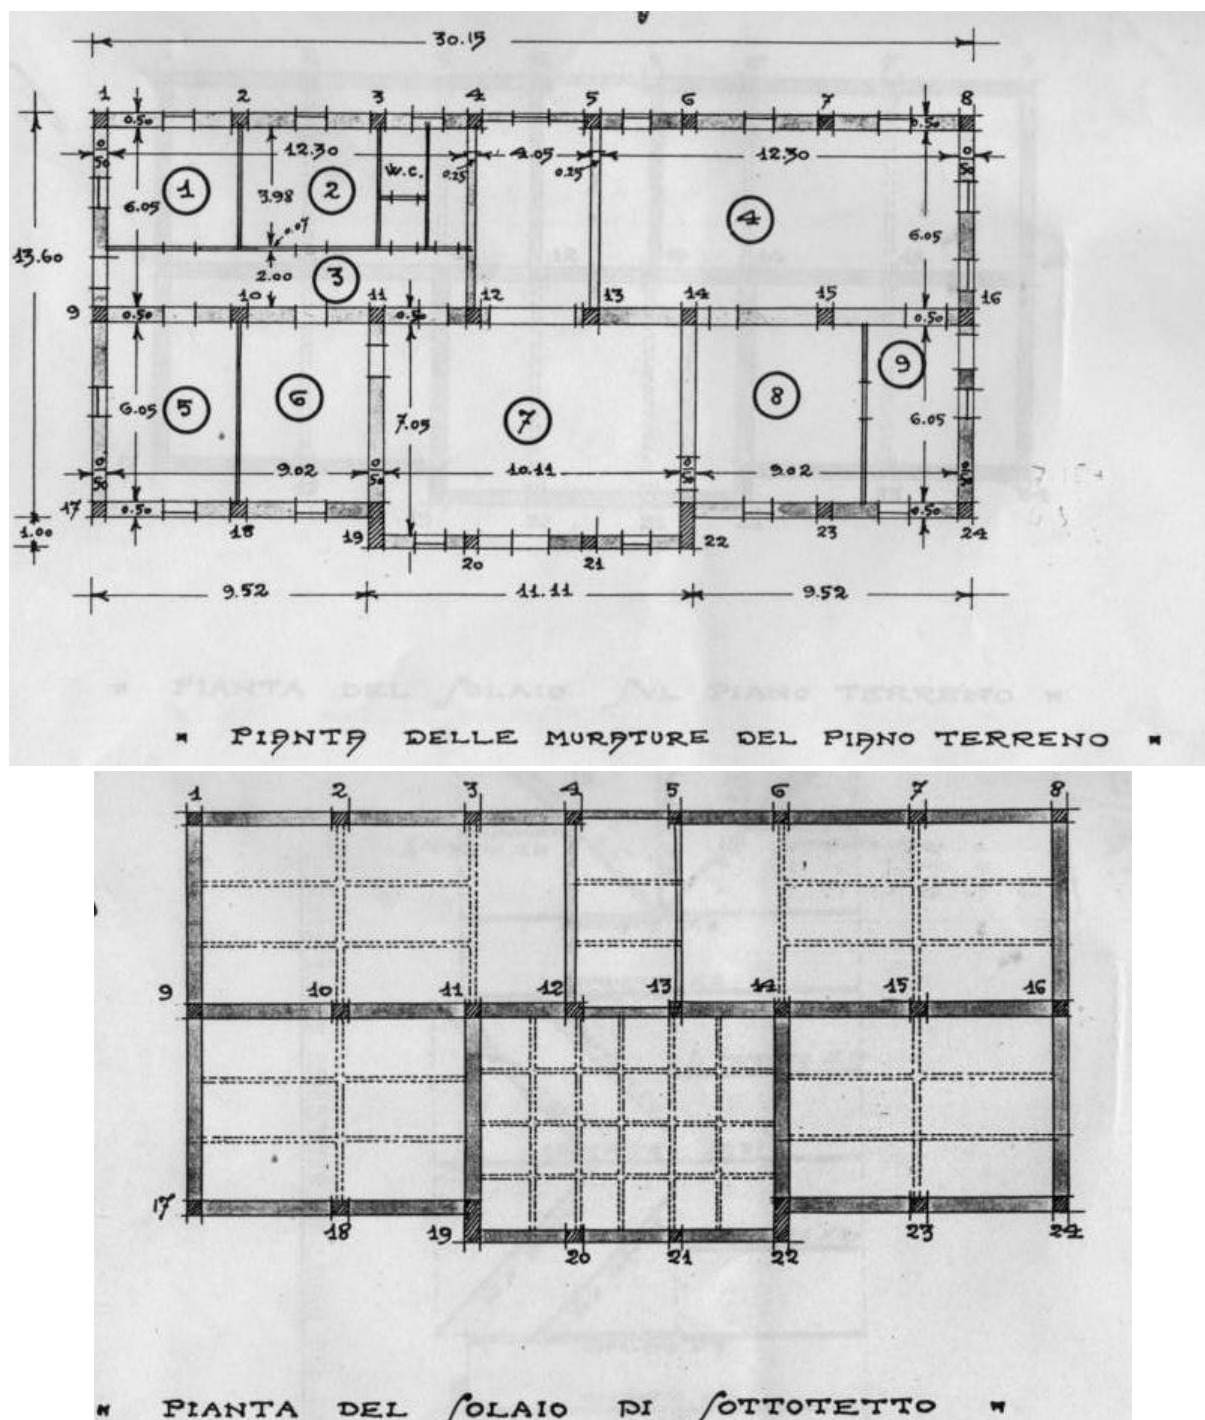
Stralcio del progetto originale dell'Edificio Comunale.
